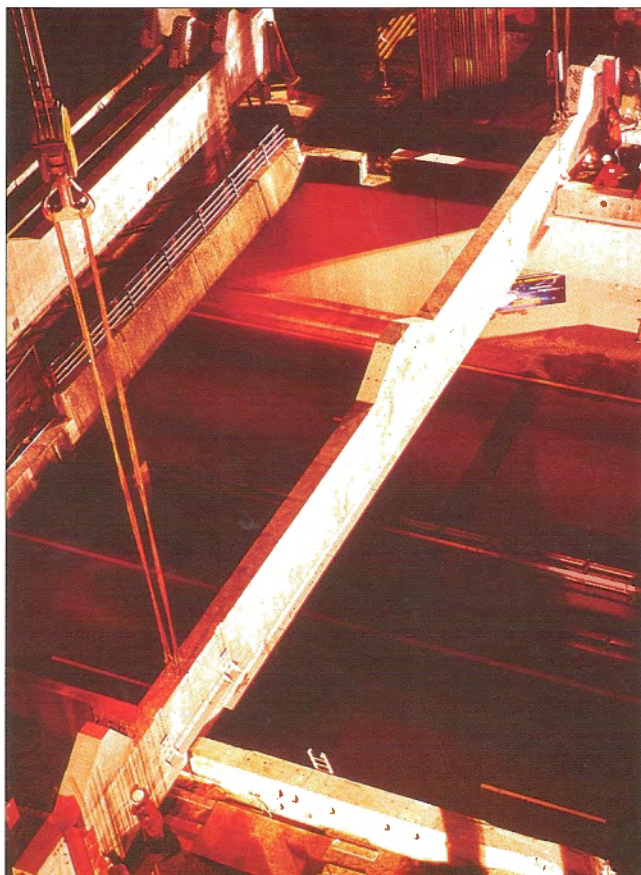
Detail ložiska roznášecího nosníku na základovém nosníku / Detail of bearing of the transfer truss on the foundations beams
